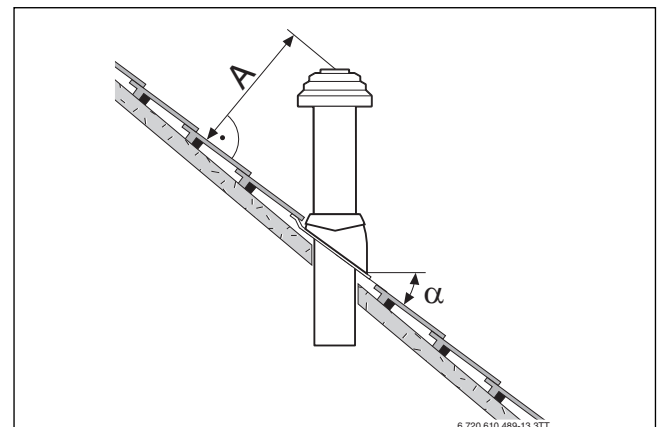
Abstandsmaße und Dachneigungen bei Schrägdach
